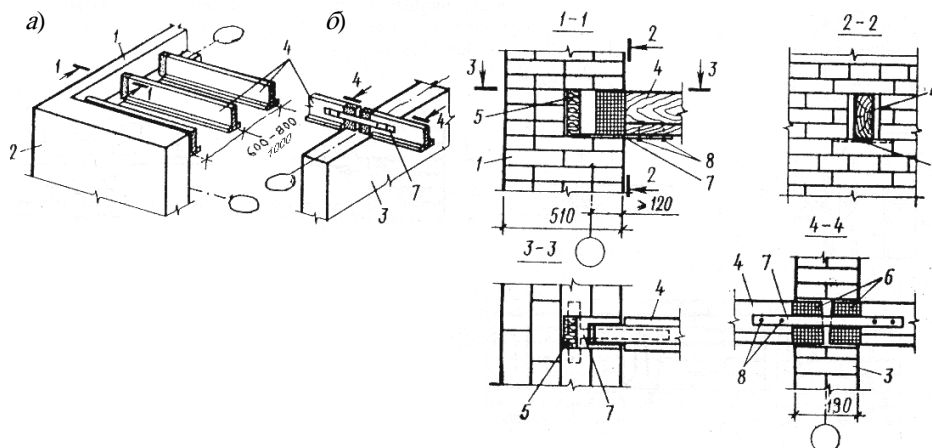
Опираие деревянных оалок перекрытия на каменные стены:
